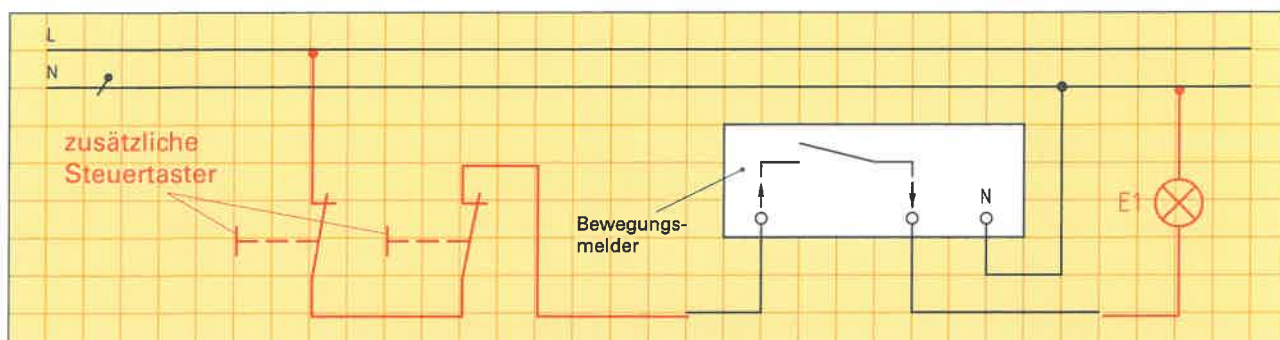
Stromlaufplan für Installationsschaltung mit IR-Bewegungsmelder
